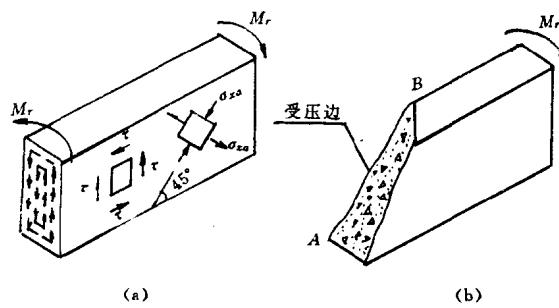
无筋矩形混凝土受扭矩破坏示意图
